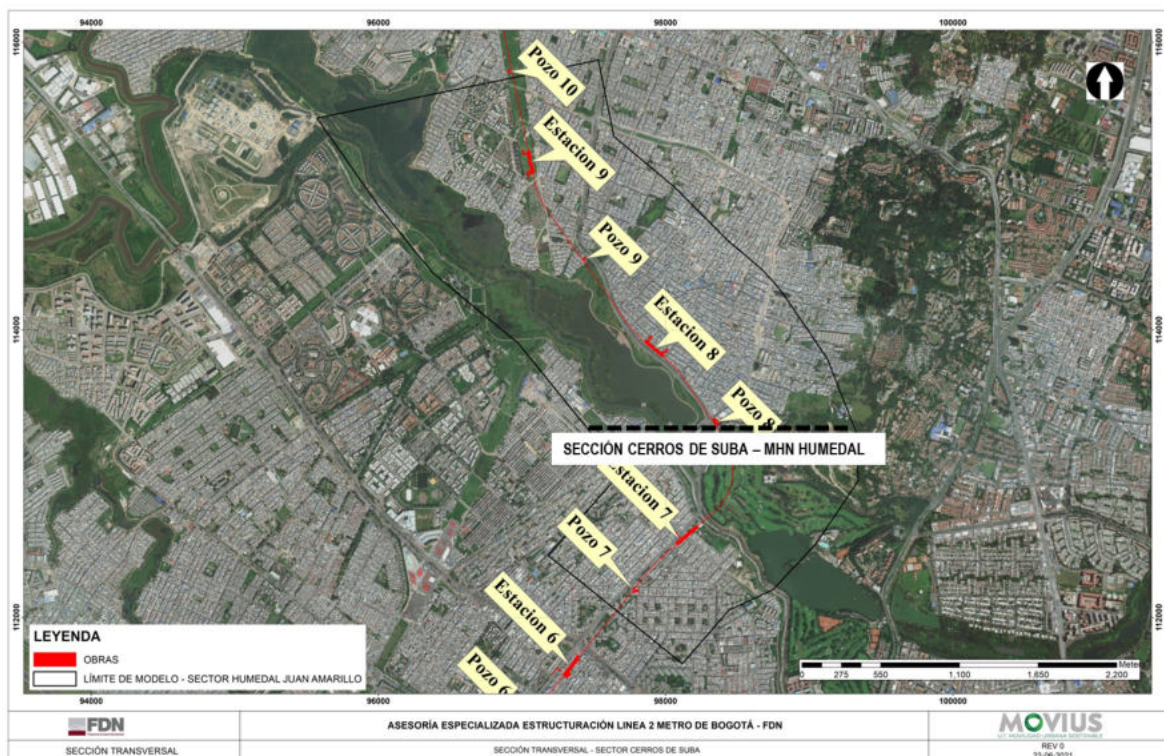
Ubicación en planta sección transversal - Sector Cerros de Suba, fila 252 del modelo.
